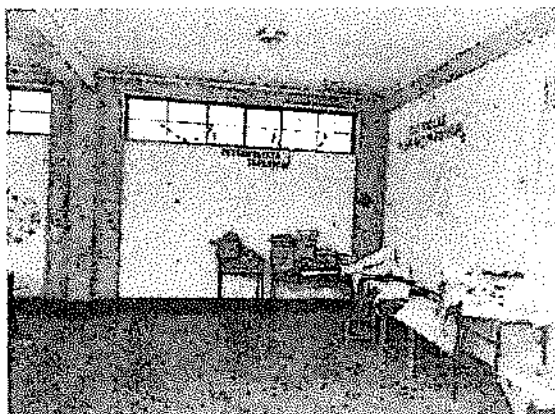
Vista de la junta de dilatación en el pabellón 01
